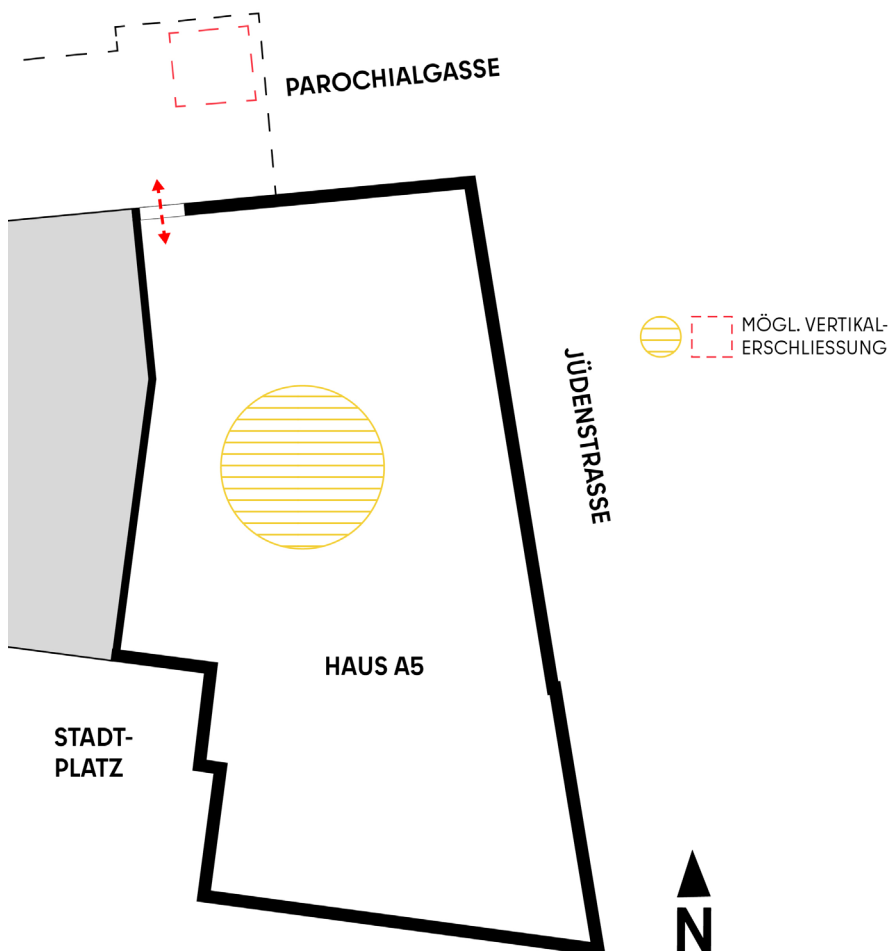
Schematischer Grundriss Untergeschoss (mit noch zu prüfendem Pavillon im Bereich der Parochialgasse)
